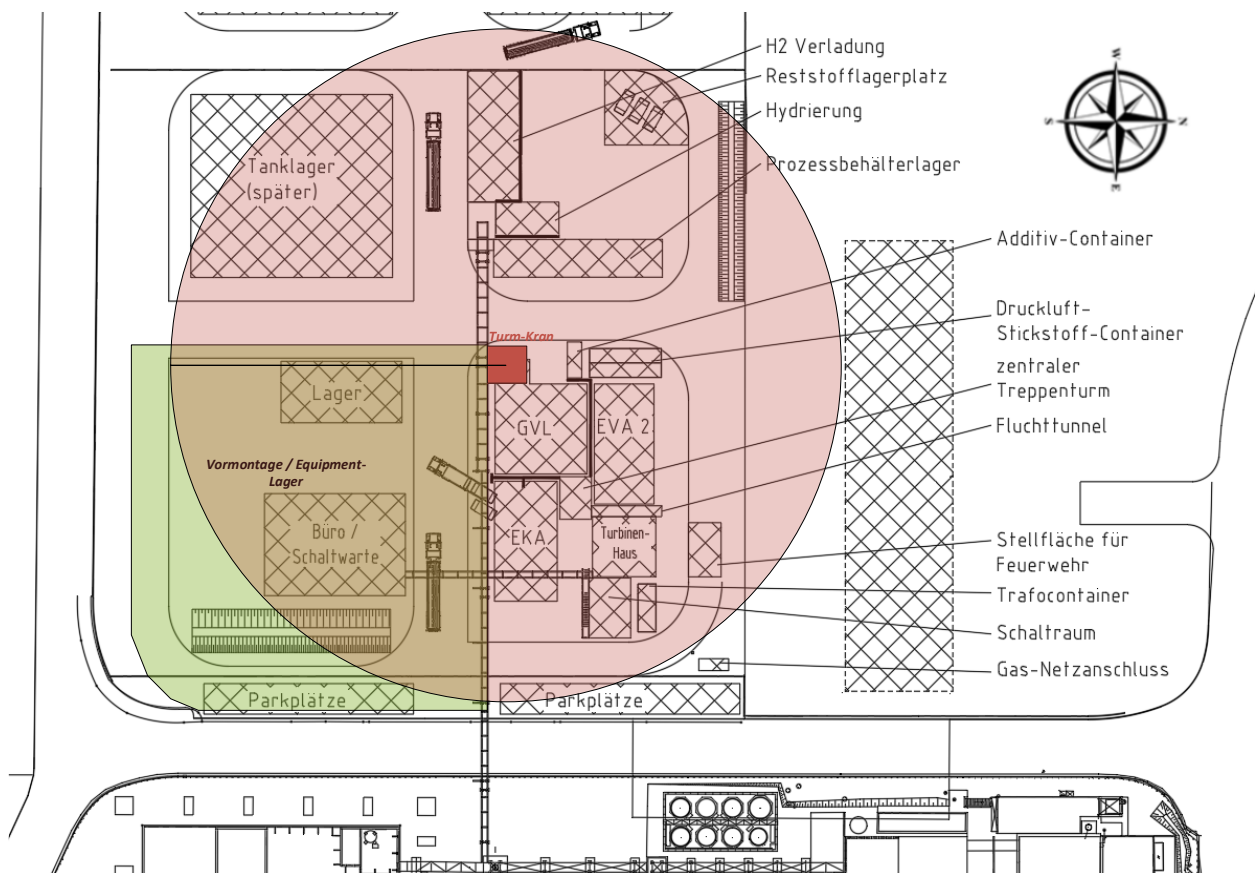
Grundriss mit eingetragener Fläche für Vormontage und Equipmentlagerung in grün, sowie Aufstellungsbereich des Turm-Krans.
